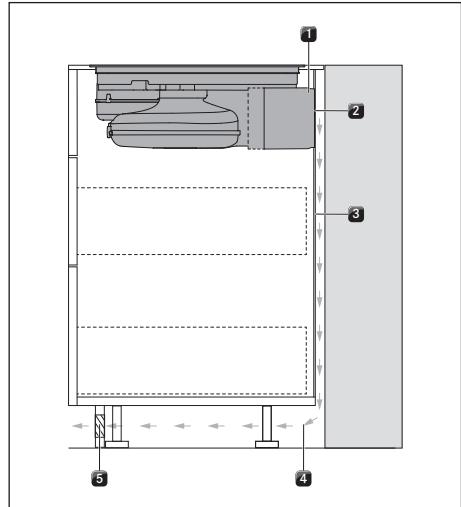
Montagevariante mit durchgehender Rückwand
